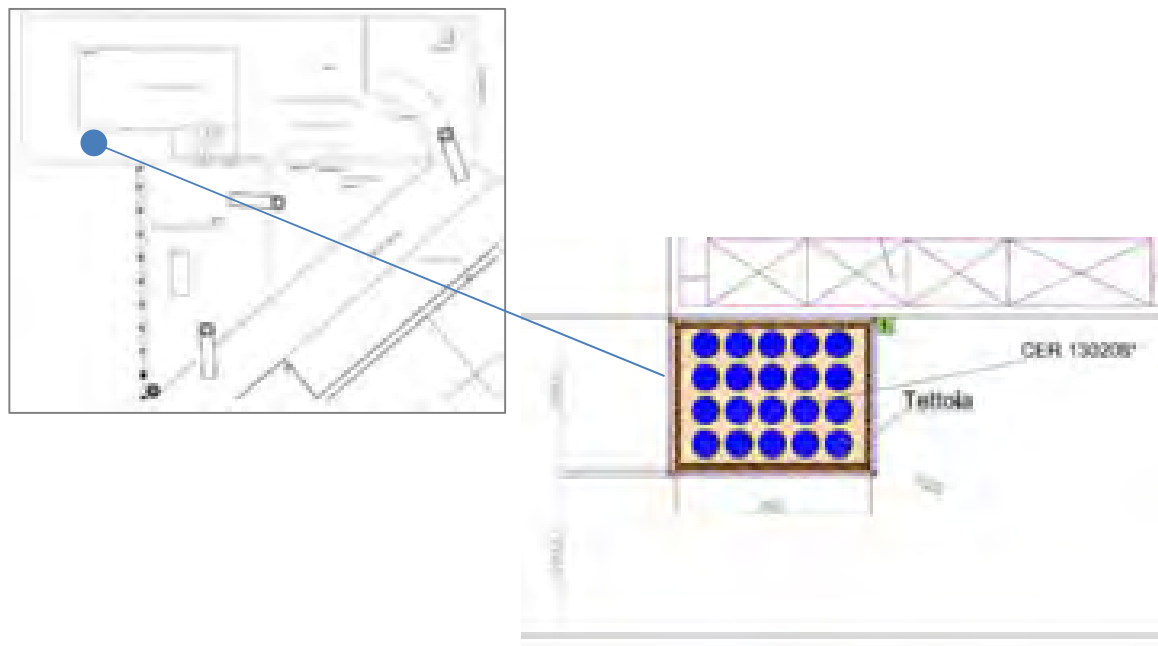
Estratto Planimetria Generale – Stoccaggio CER 130208
